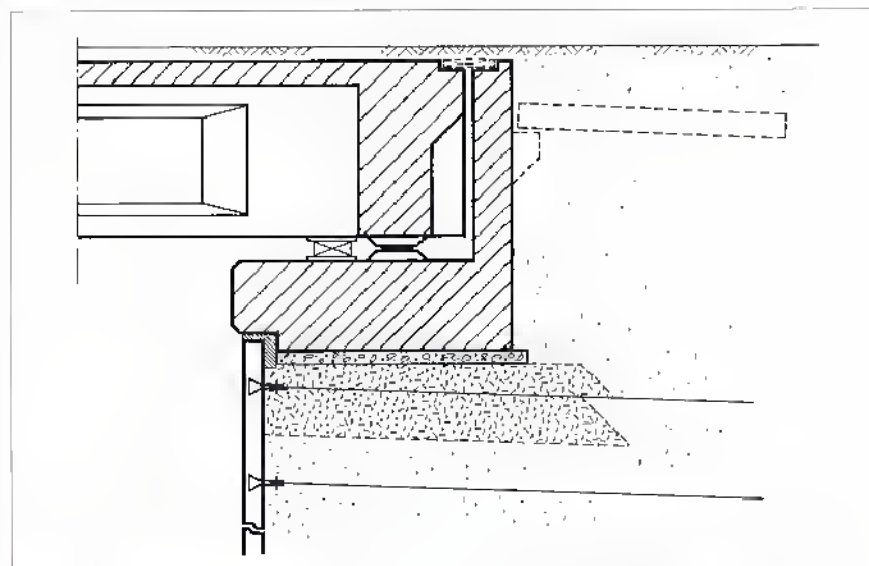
Détails types d'un sommier de pont à poutres: vérins de relevage et dalle de transition éventuels.
